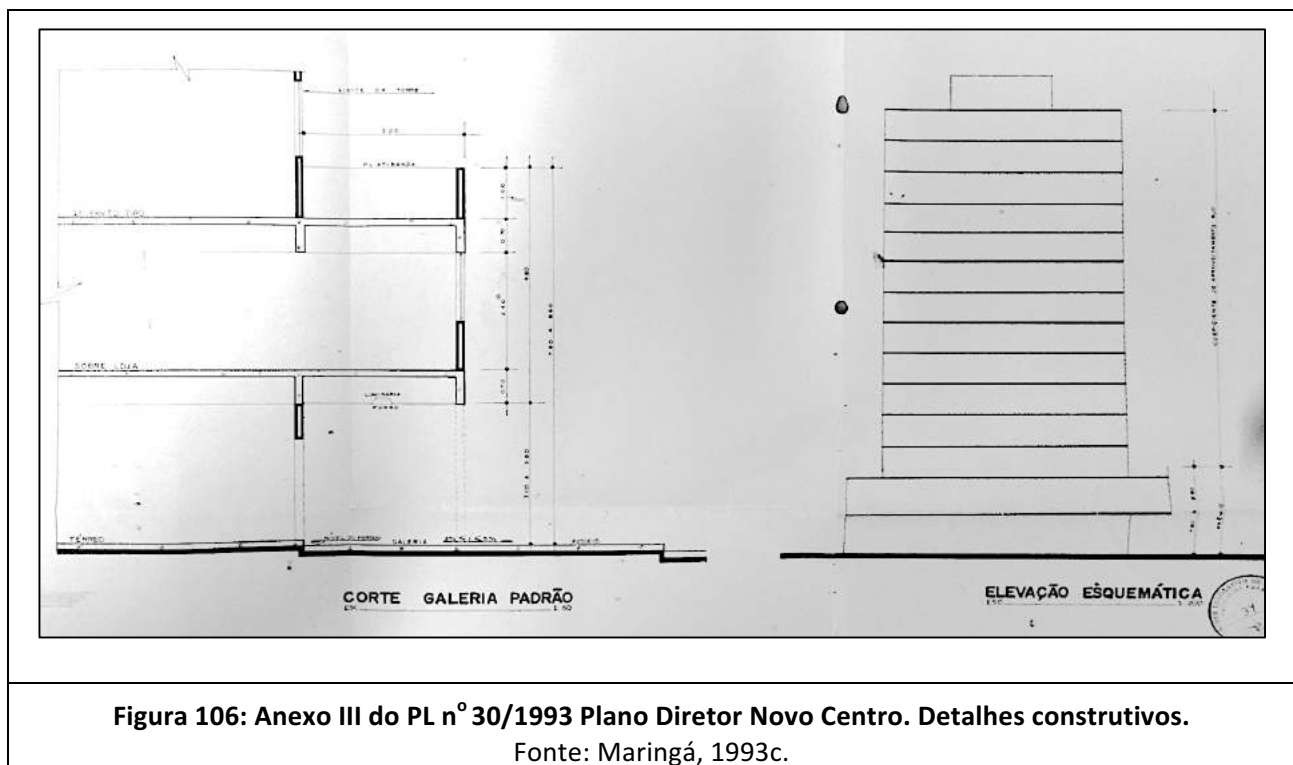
Anexo III do PL nº 30/1993 Plano Diretor Novo Centro. Detalhes construtivos.
